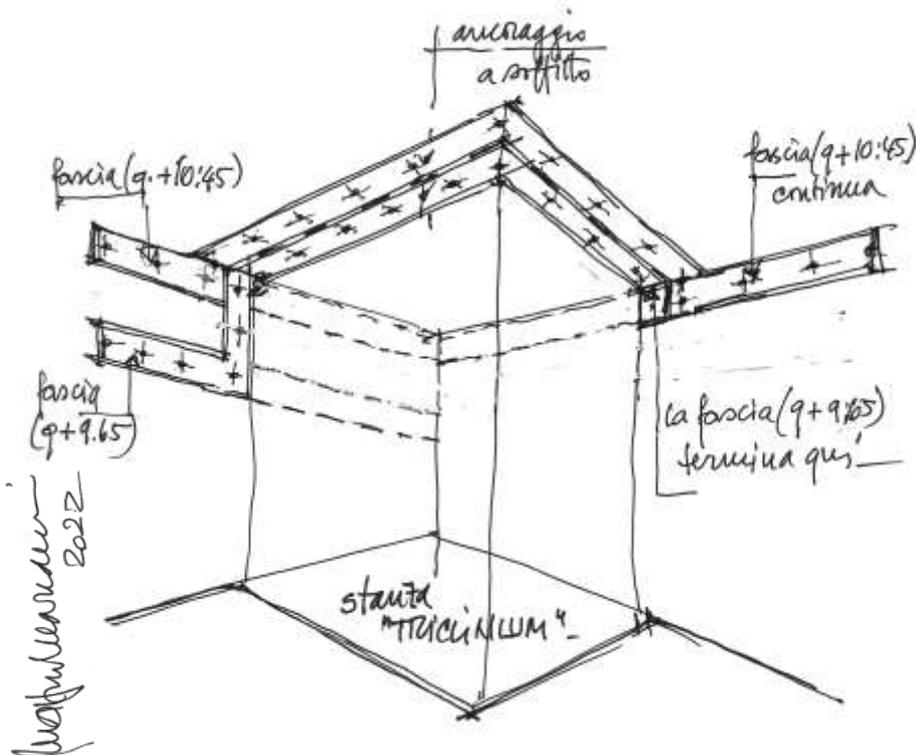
CONTINUITA' TRA LE FASCE-TIRANTI PERIMETRALI OTTENUTA A SOFFITTO CON PROFILATO PIATTO
